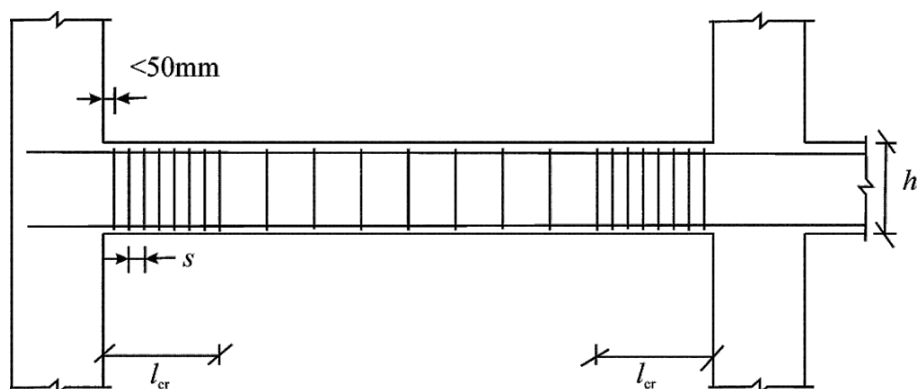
Armaduras transversais em zonas críticas das vigas [NP EN1998-1 (2009)]
